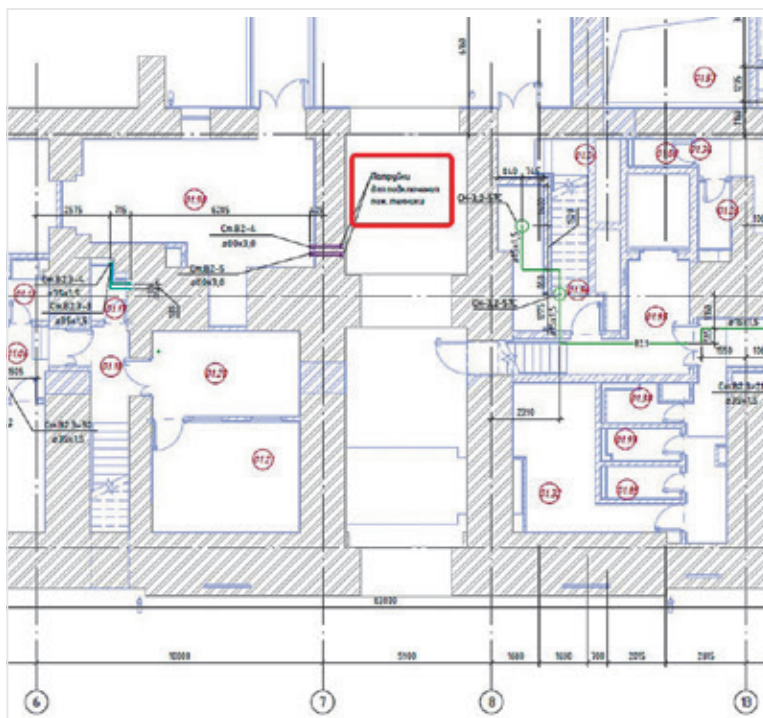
Вид размещения патрубков в арке на плане цокольного этажа на отметке -3.200
